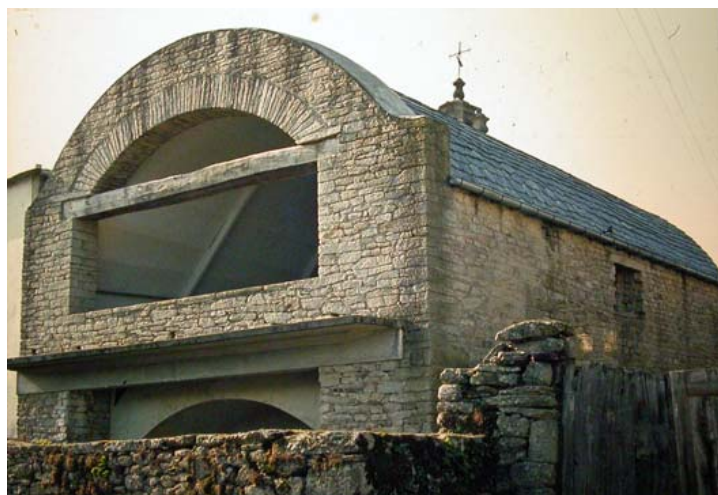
Planta superior incorporada al monumento una vez construida. Arriba vista de la fachada oeste.
